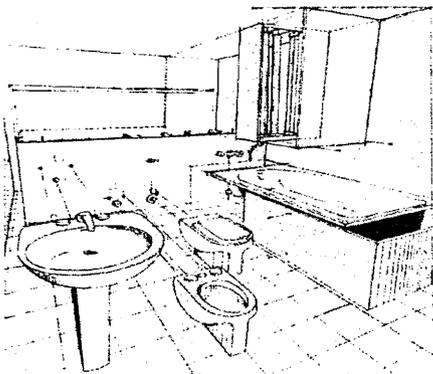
En la foto de abajo, el mueble que contiene las tuberías, debe completarse por la parte de arriba con una fachada de compensación de acuerdo a la altura del solar del ambiente en el cual está siendo instalado.
